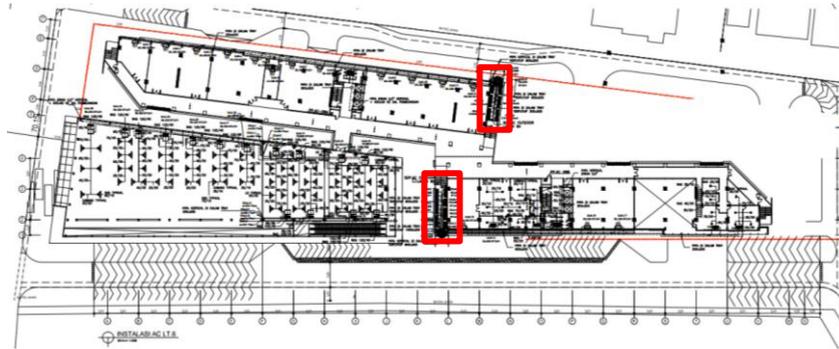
Denah posisi outdoor vrv pada lantai 1
